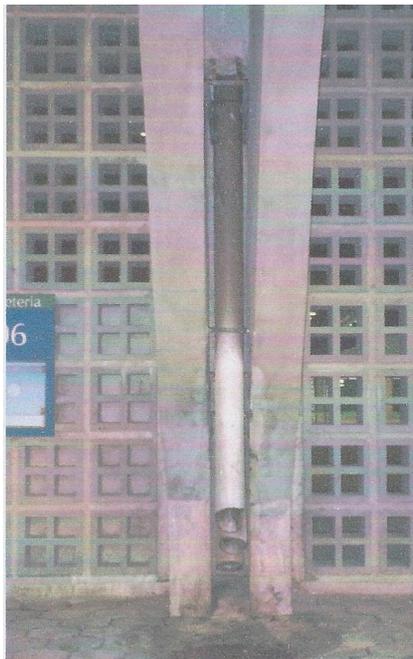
Mostra Conductor em Concreto e em tubos de PVC
